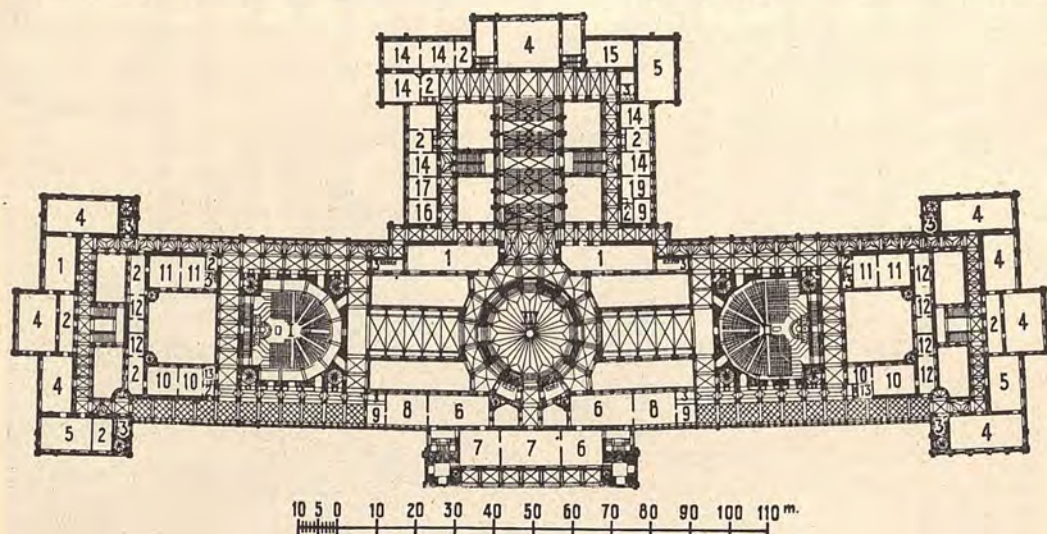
a, b. — Parlamento di Budapest (arch. Steindl).
